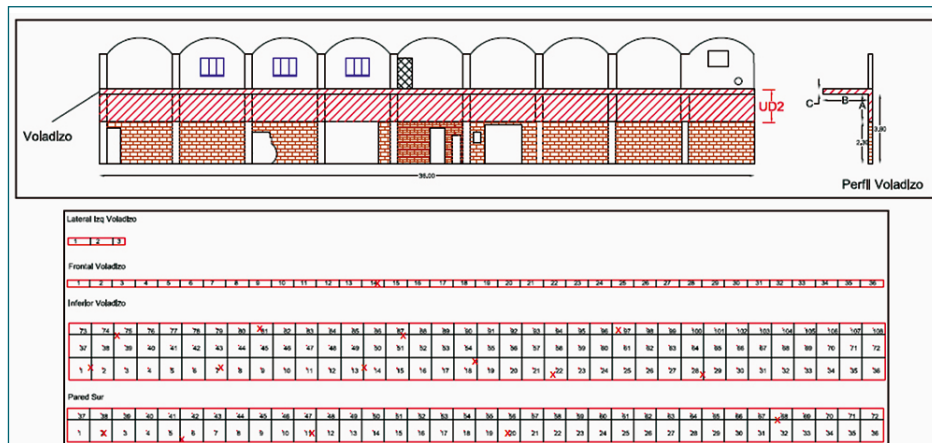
Alzado y plano generado por la aplicación SUDES para UD-1-UP.
